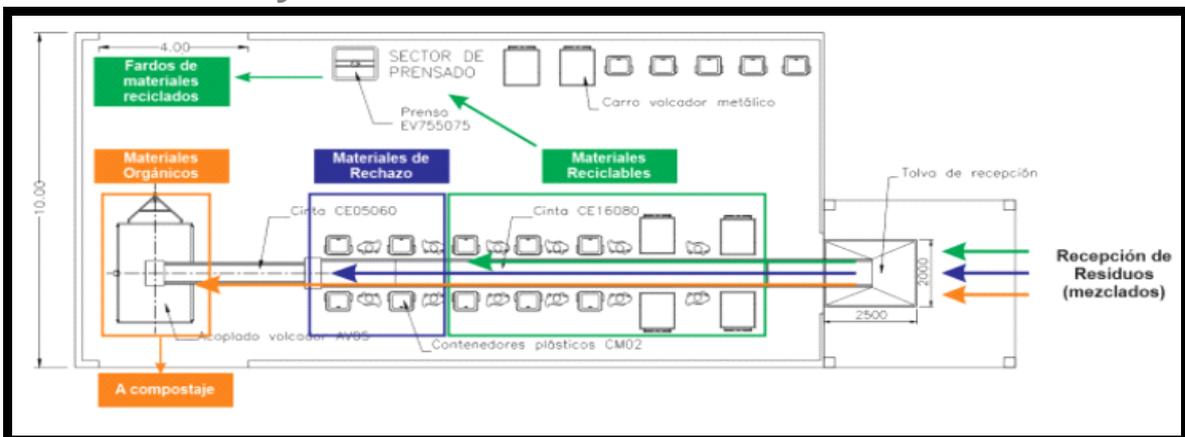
Funcionamiento de la planta en planta. Fuente: Municipalidad de ASN.
